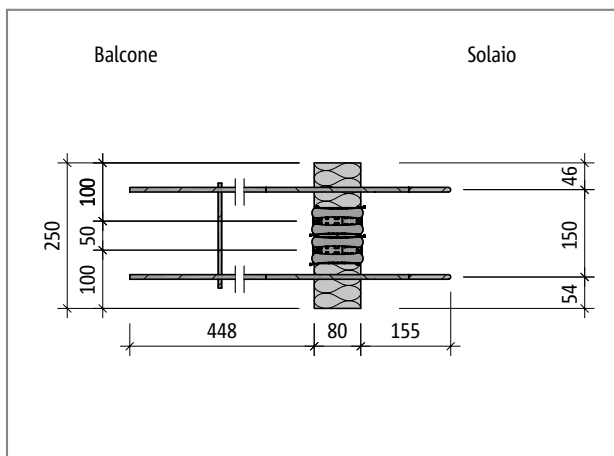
Schöck Isokorb® tipo QP10S: pianta del prodotto
